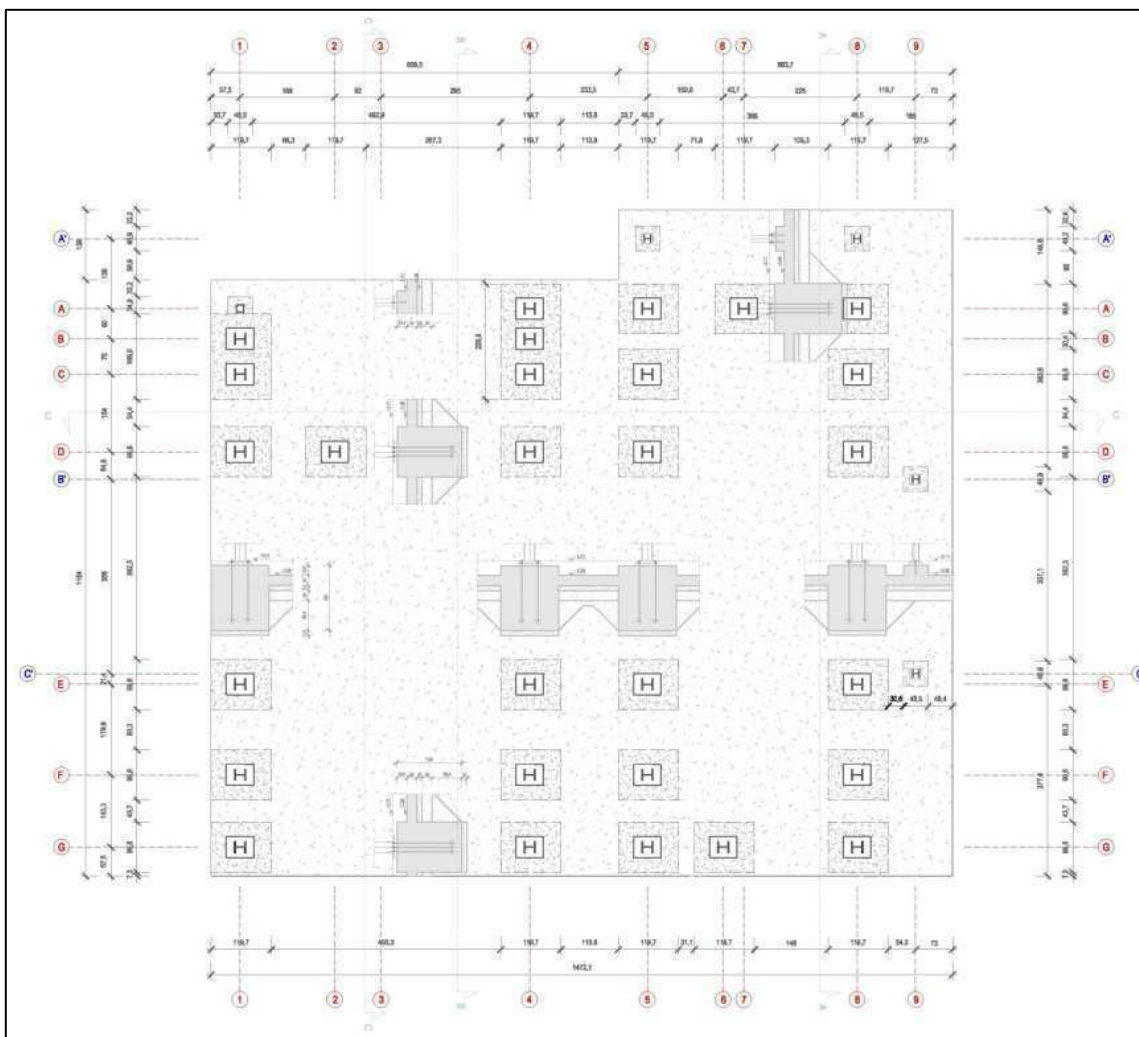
Pianta Fondazioni; Tavola 1.
